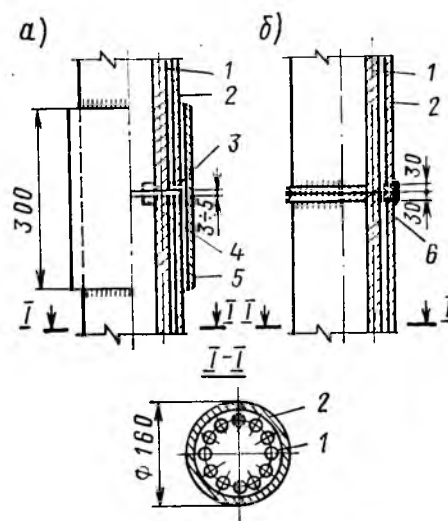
Конструкция трубобетонных образцов а — стык с обоймой; б — стык с фланцами; 1 — продольные стержни; 2 — труба-оболочка; 3 — выравнивающий слой; 4 — торцовая пластина; 5 — стыковая обойма; 6 — стыковочный фланец
